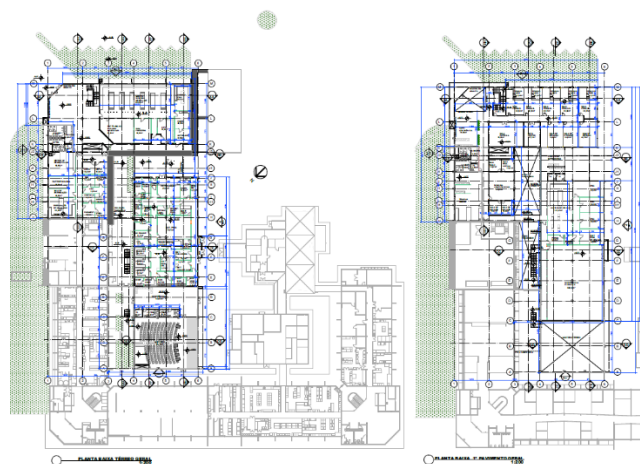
Estudo Preliminar do Centro de Saúde – Plantas gerais
